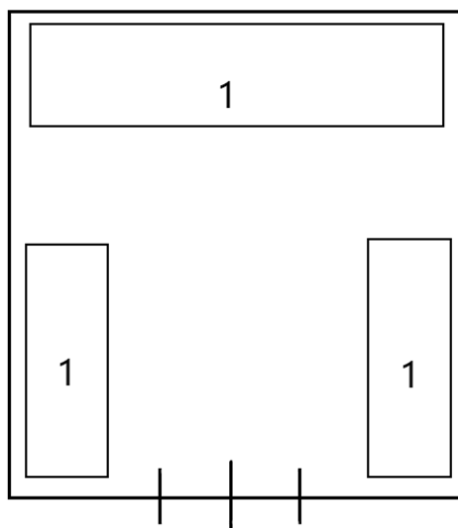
План размещения пожарной нагрузки в складском помещении №1
